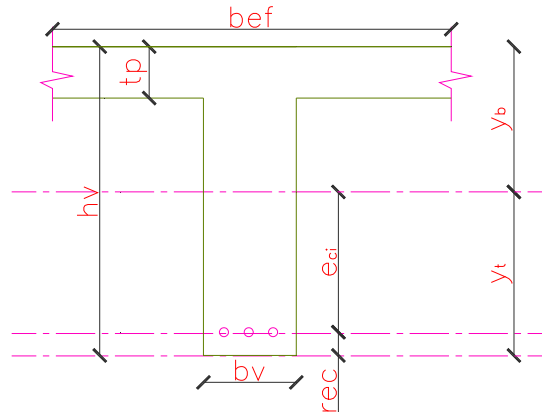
SECCIONES DE LA VIGA PARA PREESFUERZO FUENTE: PROPIA
